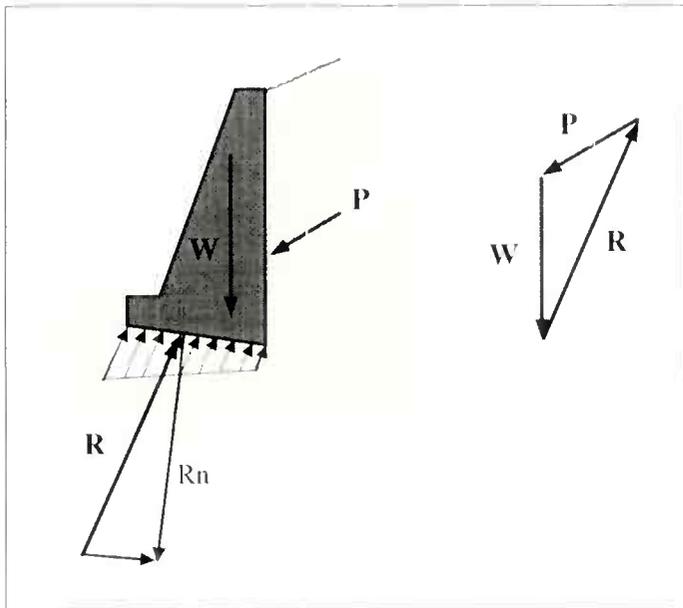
Principales actions s'exerçant sur les murs poids
